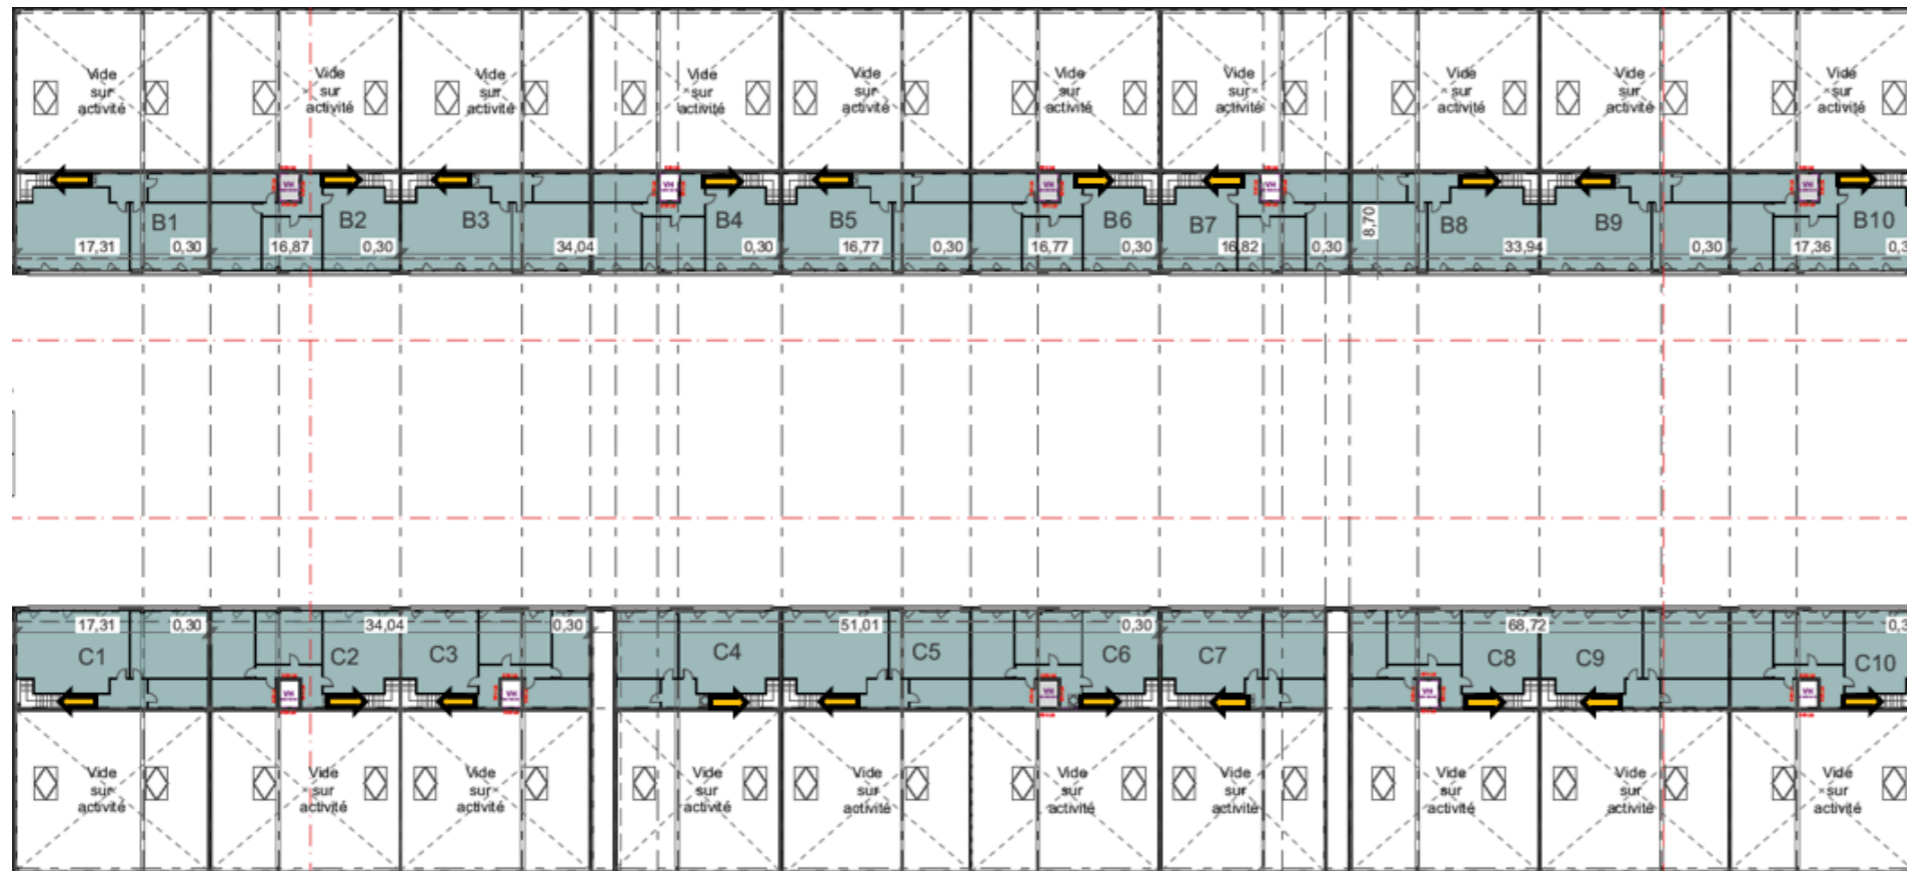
Escaliers de l'étage R+3/mezzanine
